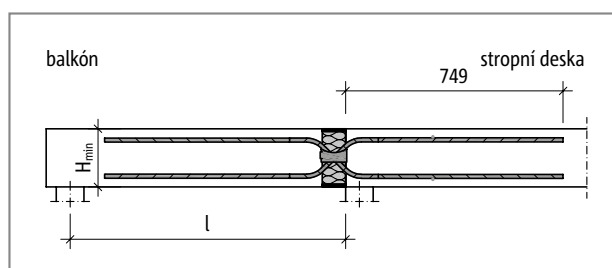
Schöck Isokorb® T typ QP-V7 a QP-V9: Statický systém
